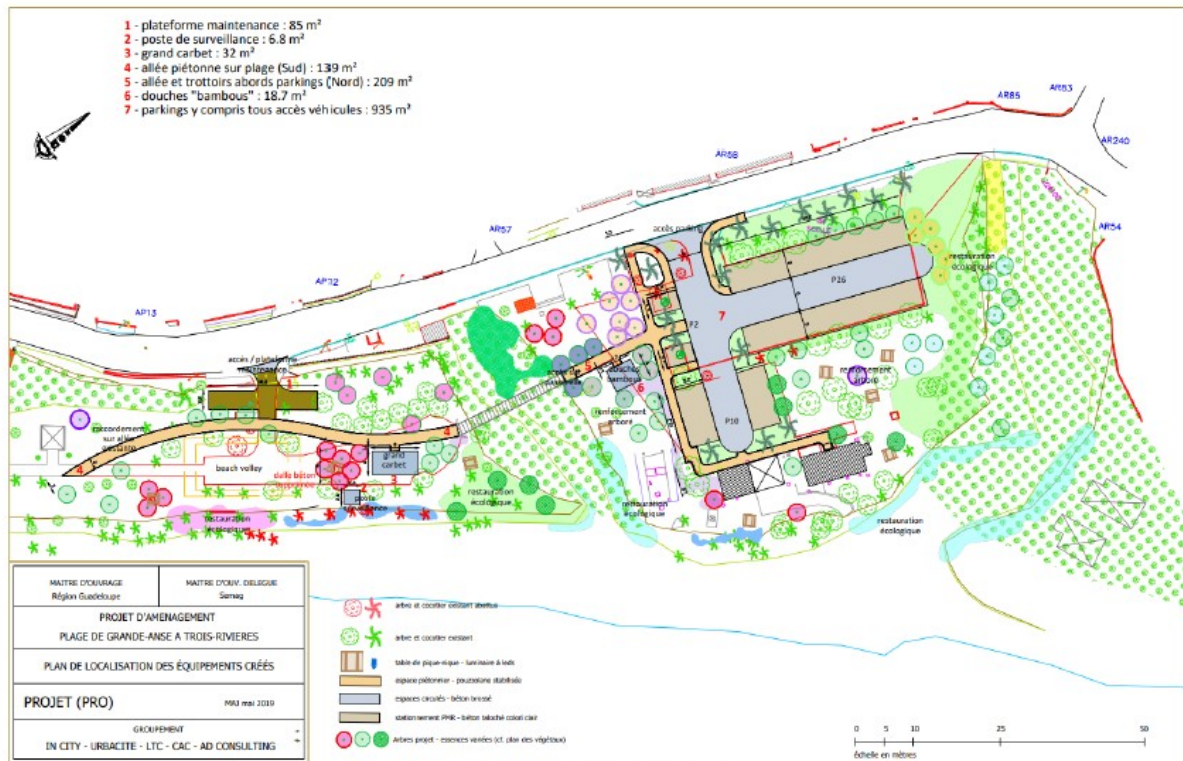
Plan de masse du projet (Source : Plan mai 2019)
